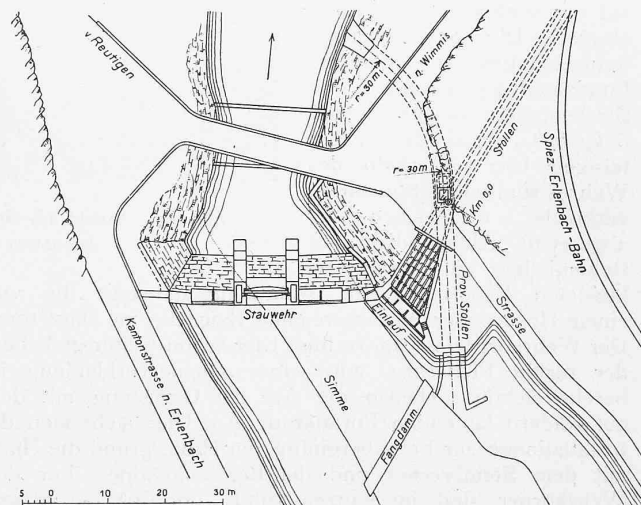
Lageplan des Simmewehrs mit dem Stolleneinlauf. Masstab 1 : 1200.
